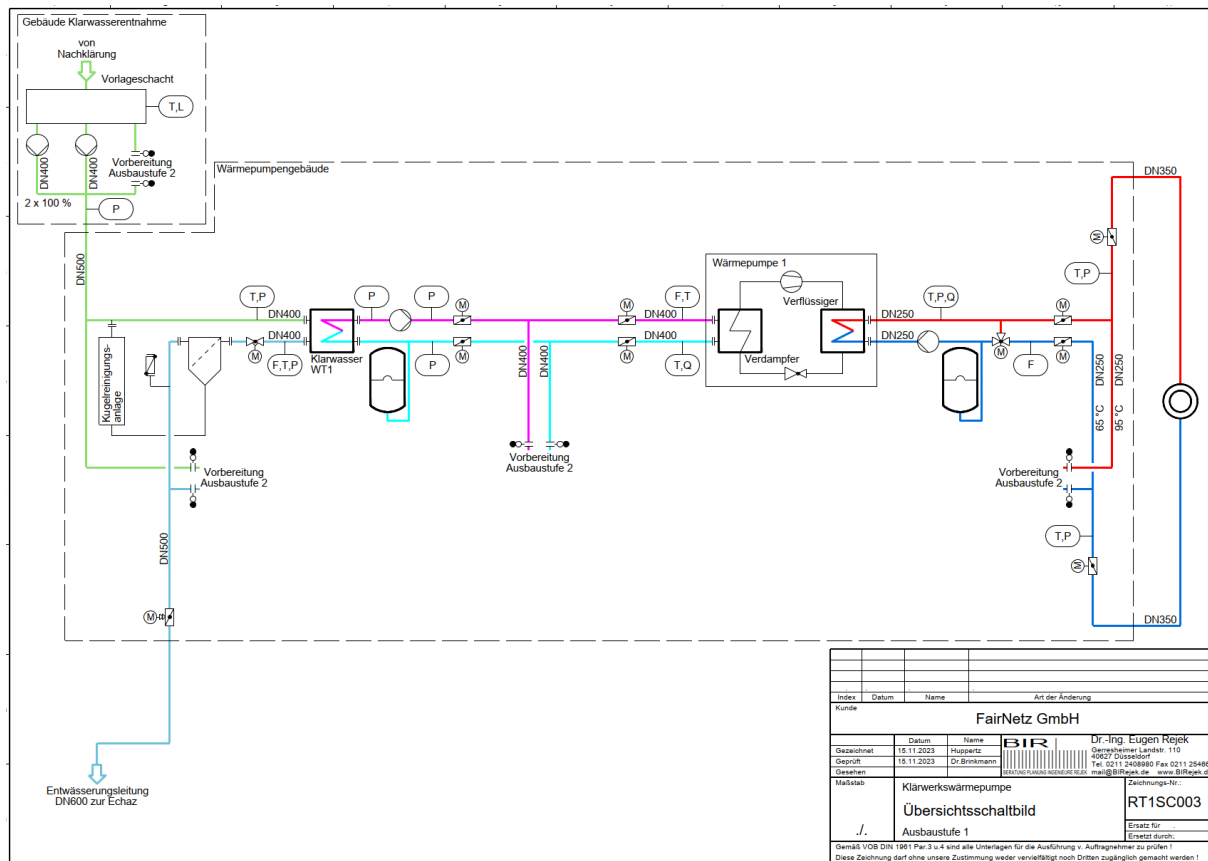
R&I-Schema der Wärmepumpenanlage
